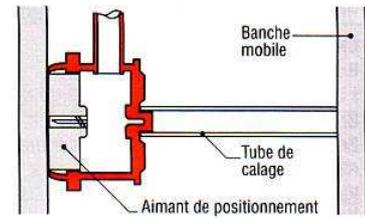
Fixation d'une boîte d'appareillage dans un coffrage vertical.
